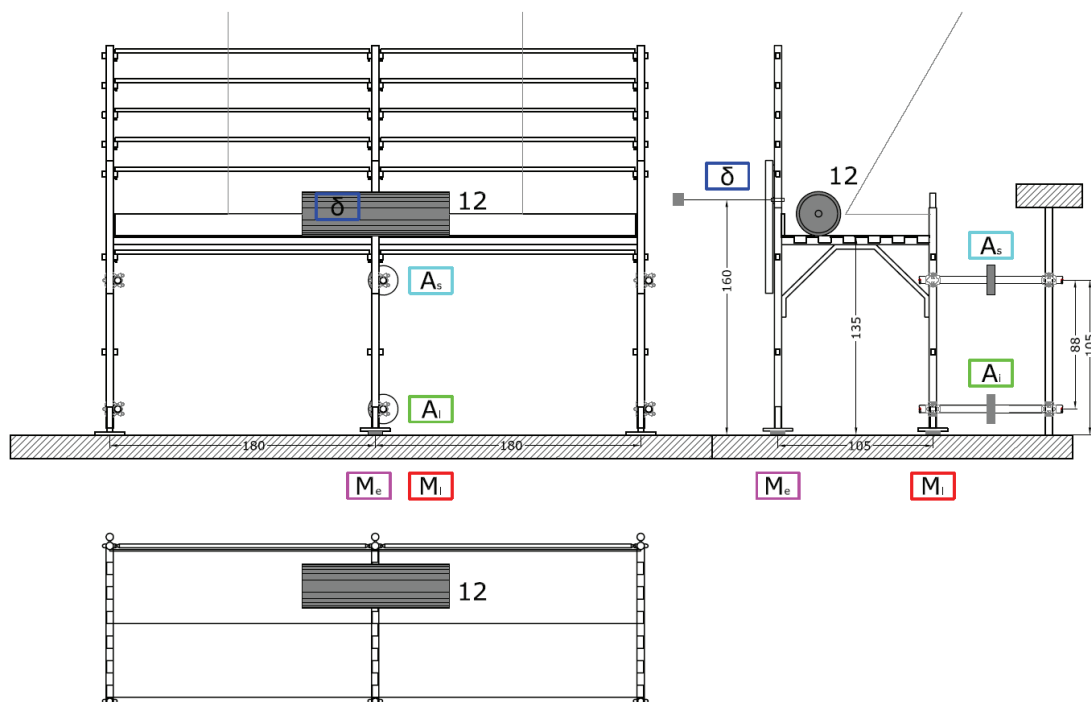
2 Prove d’impatto con rullo cilindrico su traverso – Schema CD – Posizione degli strumenti di misura
